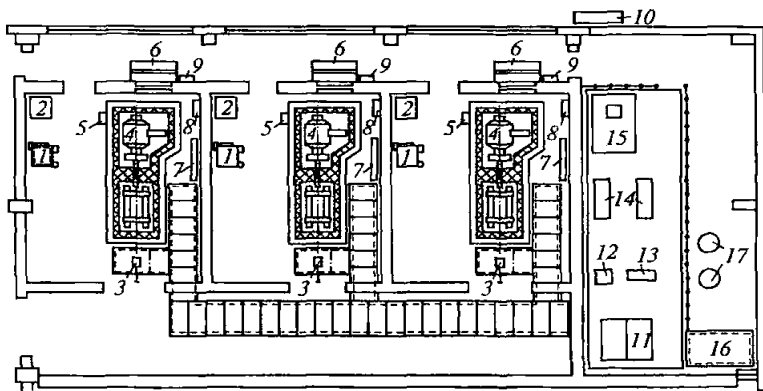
Планировка участка испытания с размещением стендов в отдельных боксах:
